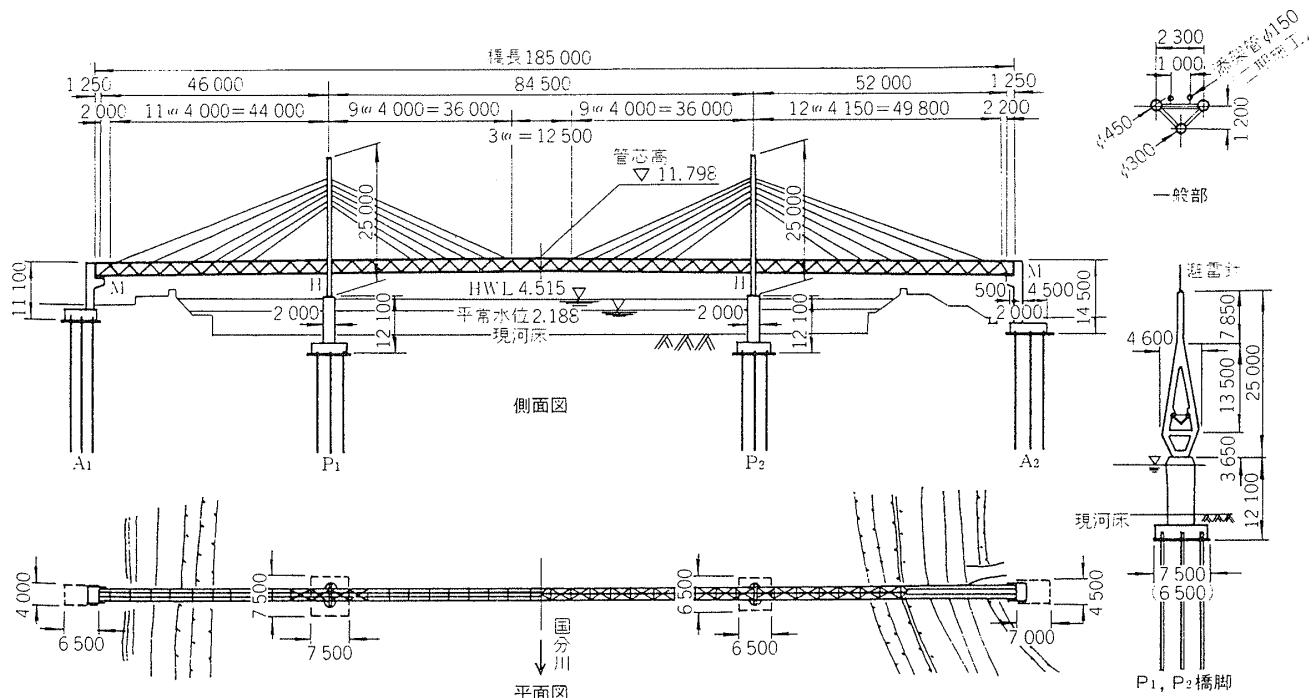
国分川水管橋（高知市）⁷⁸⁾
